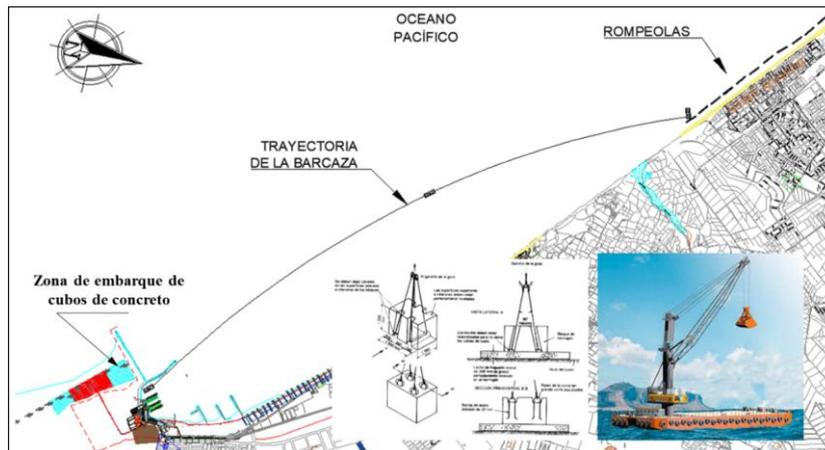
Esquema de fabricación, carga y traslado de cubos de concreto hasta el sitio de construcción.
